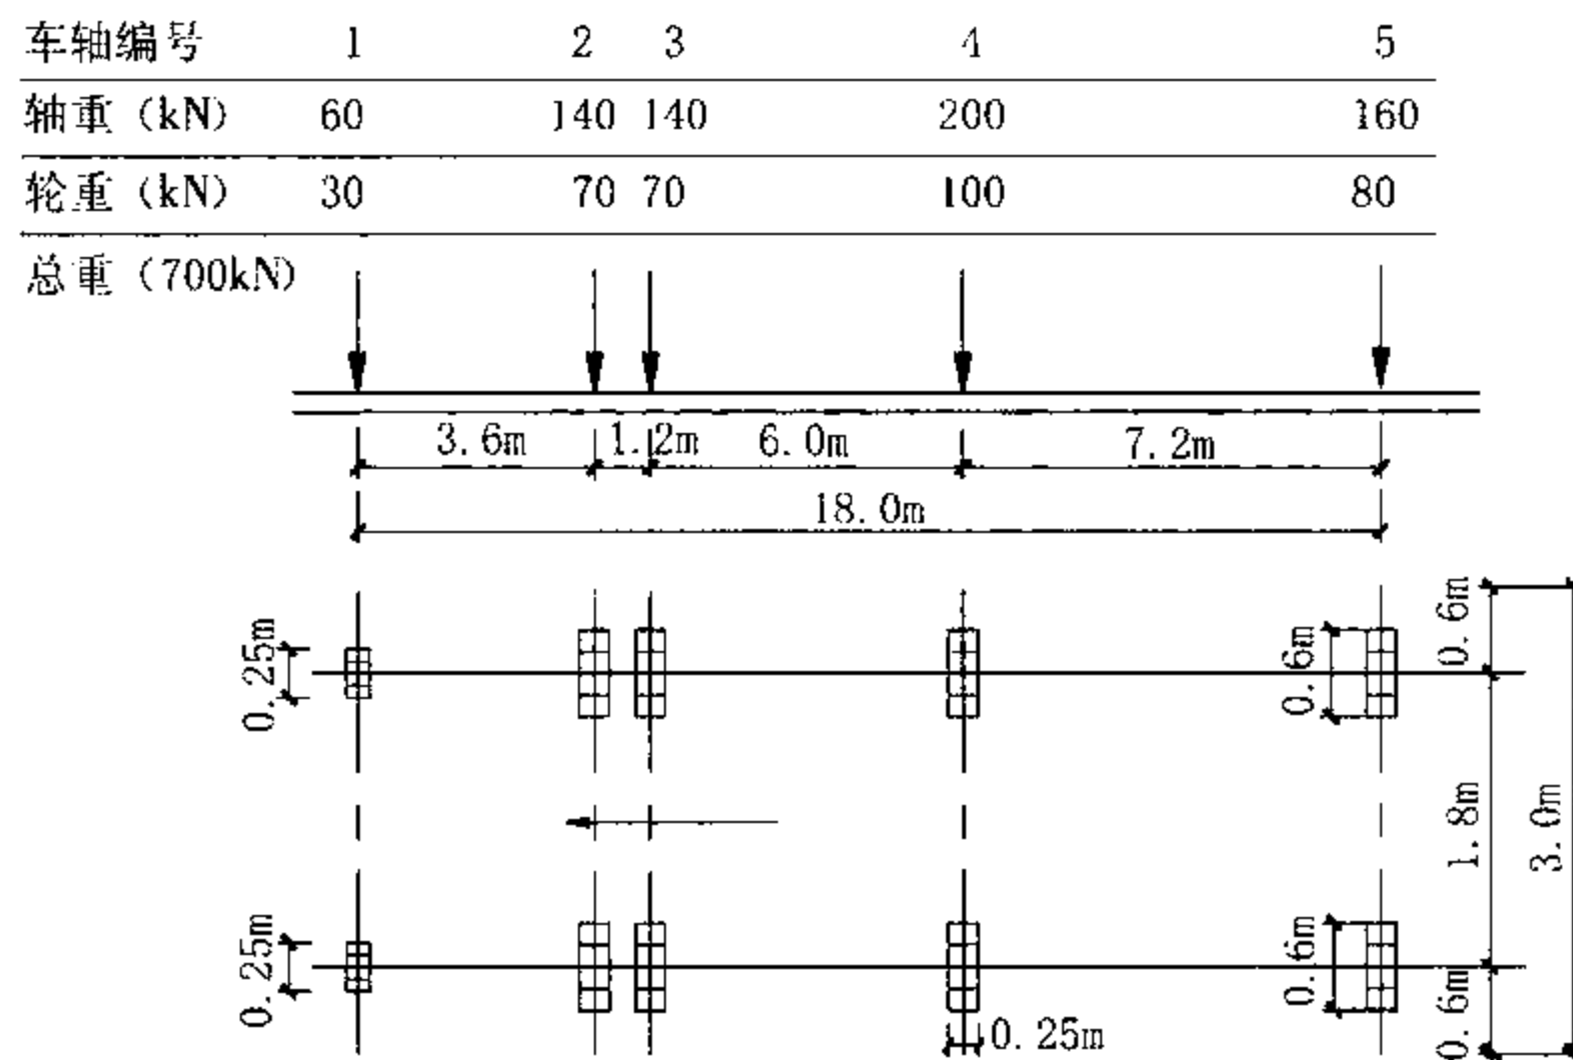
城 - A 级标准车辆纵向和平面布置
